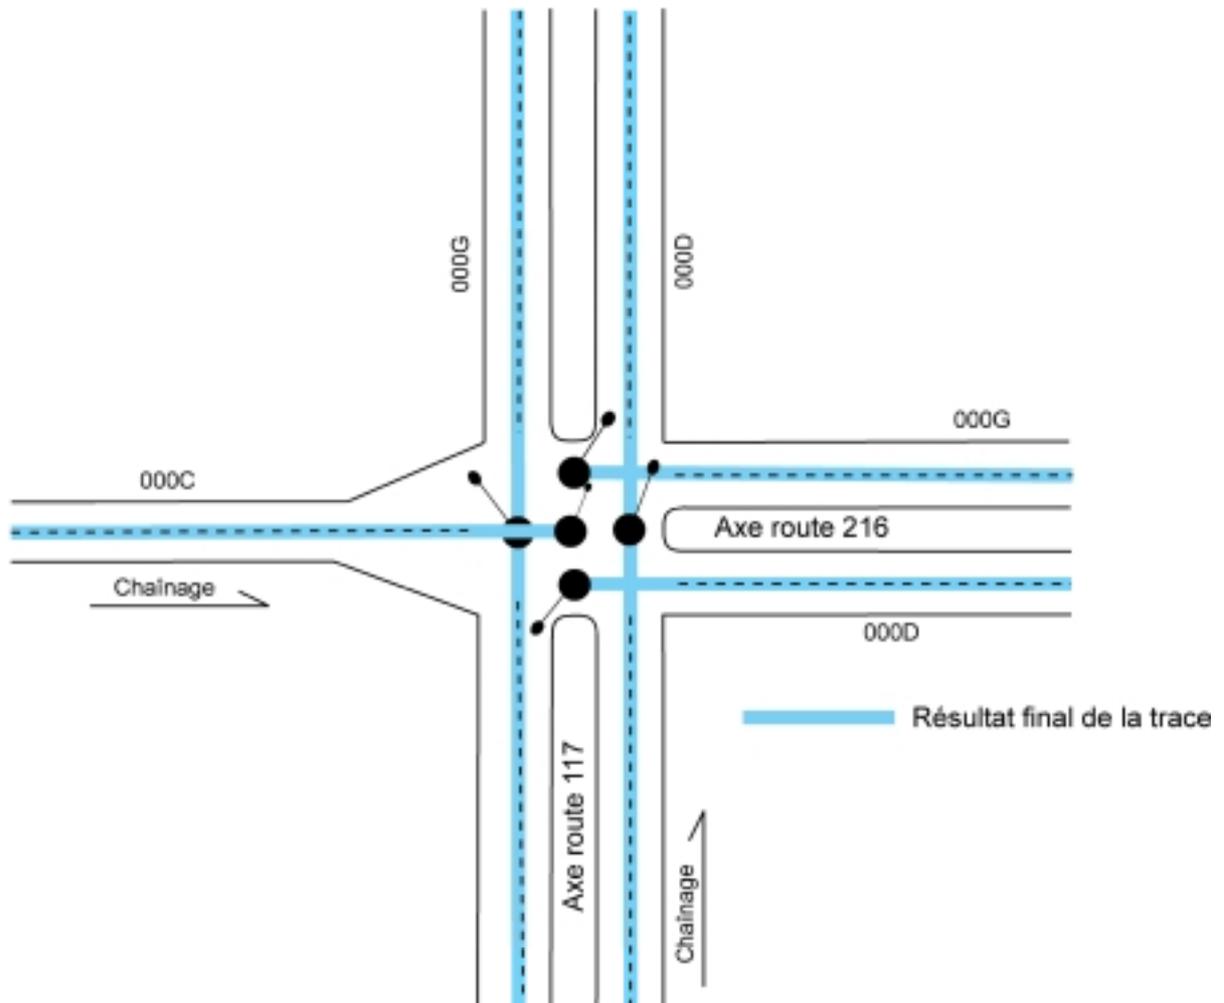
Points de sectionnement à une intersection de 8 sous-routes
